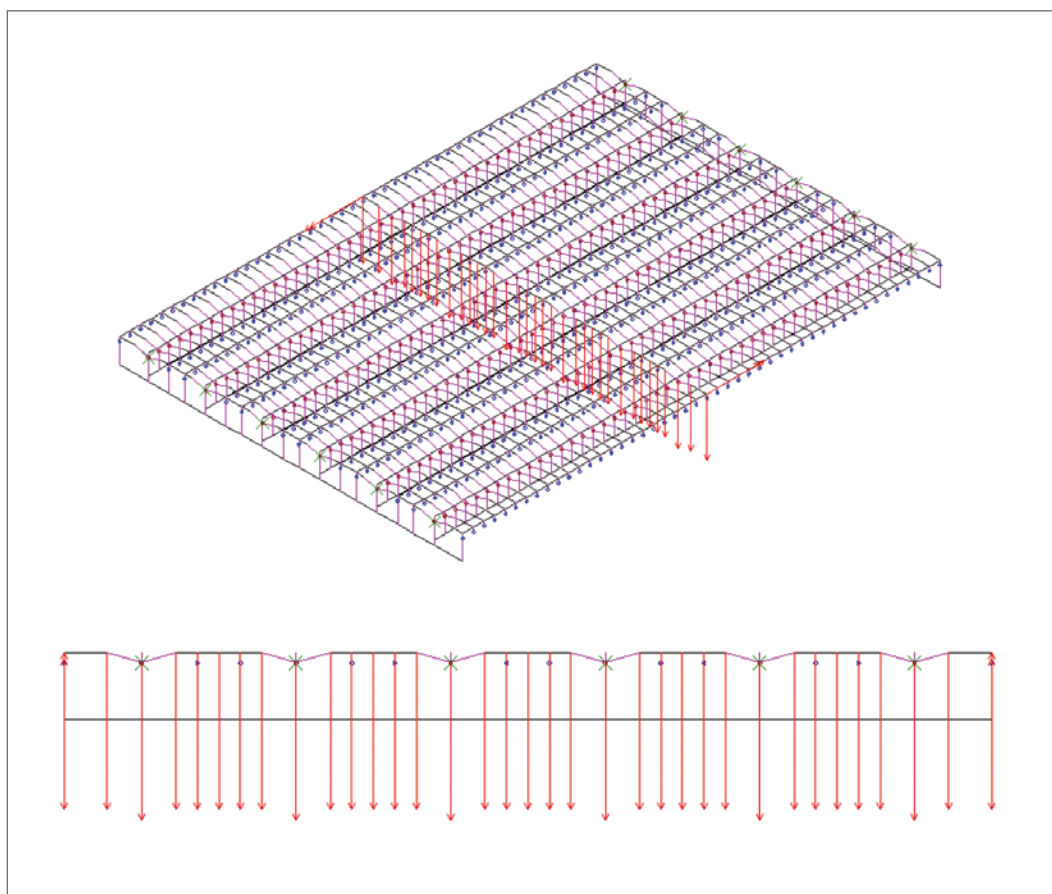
Charge ponctuelle déplacée transversalement à mi-travée (vue 3D et coupe transversale)
